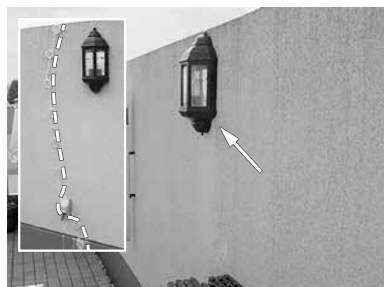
漏水ルートになった戸境壁に取付けられた、照明器具と近傍のひび割れ(左)
